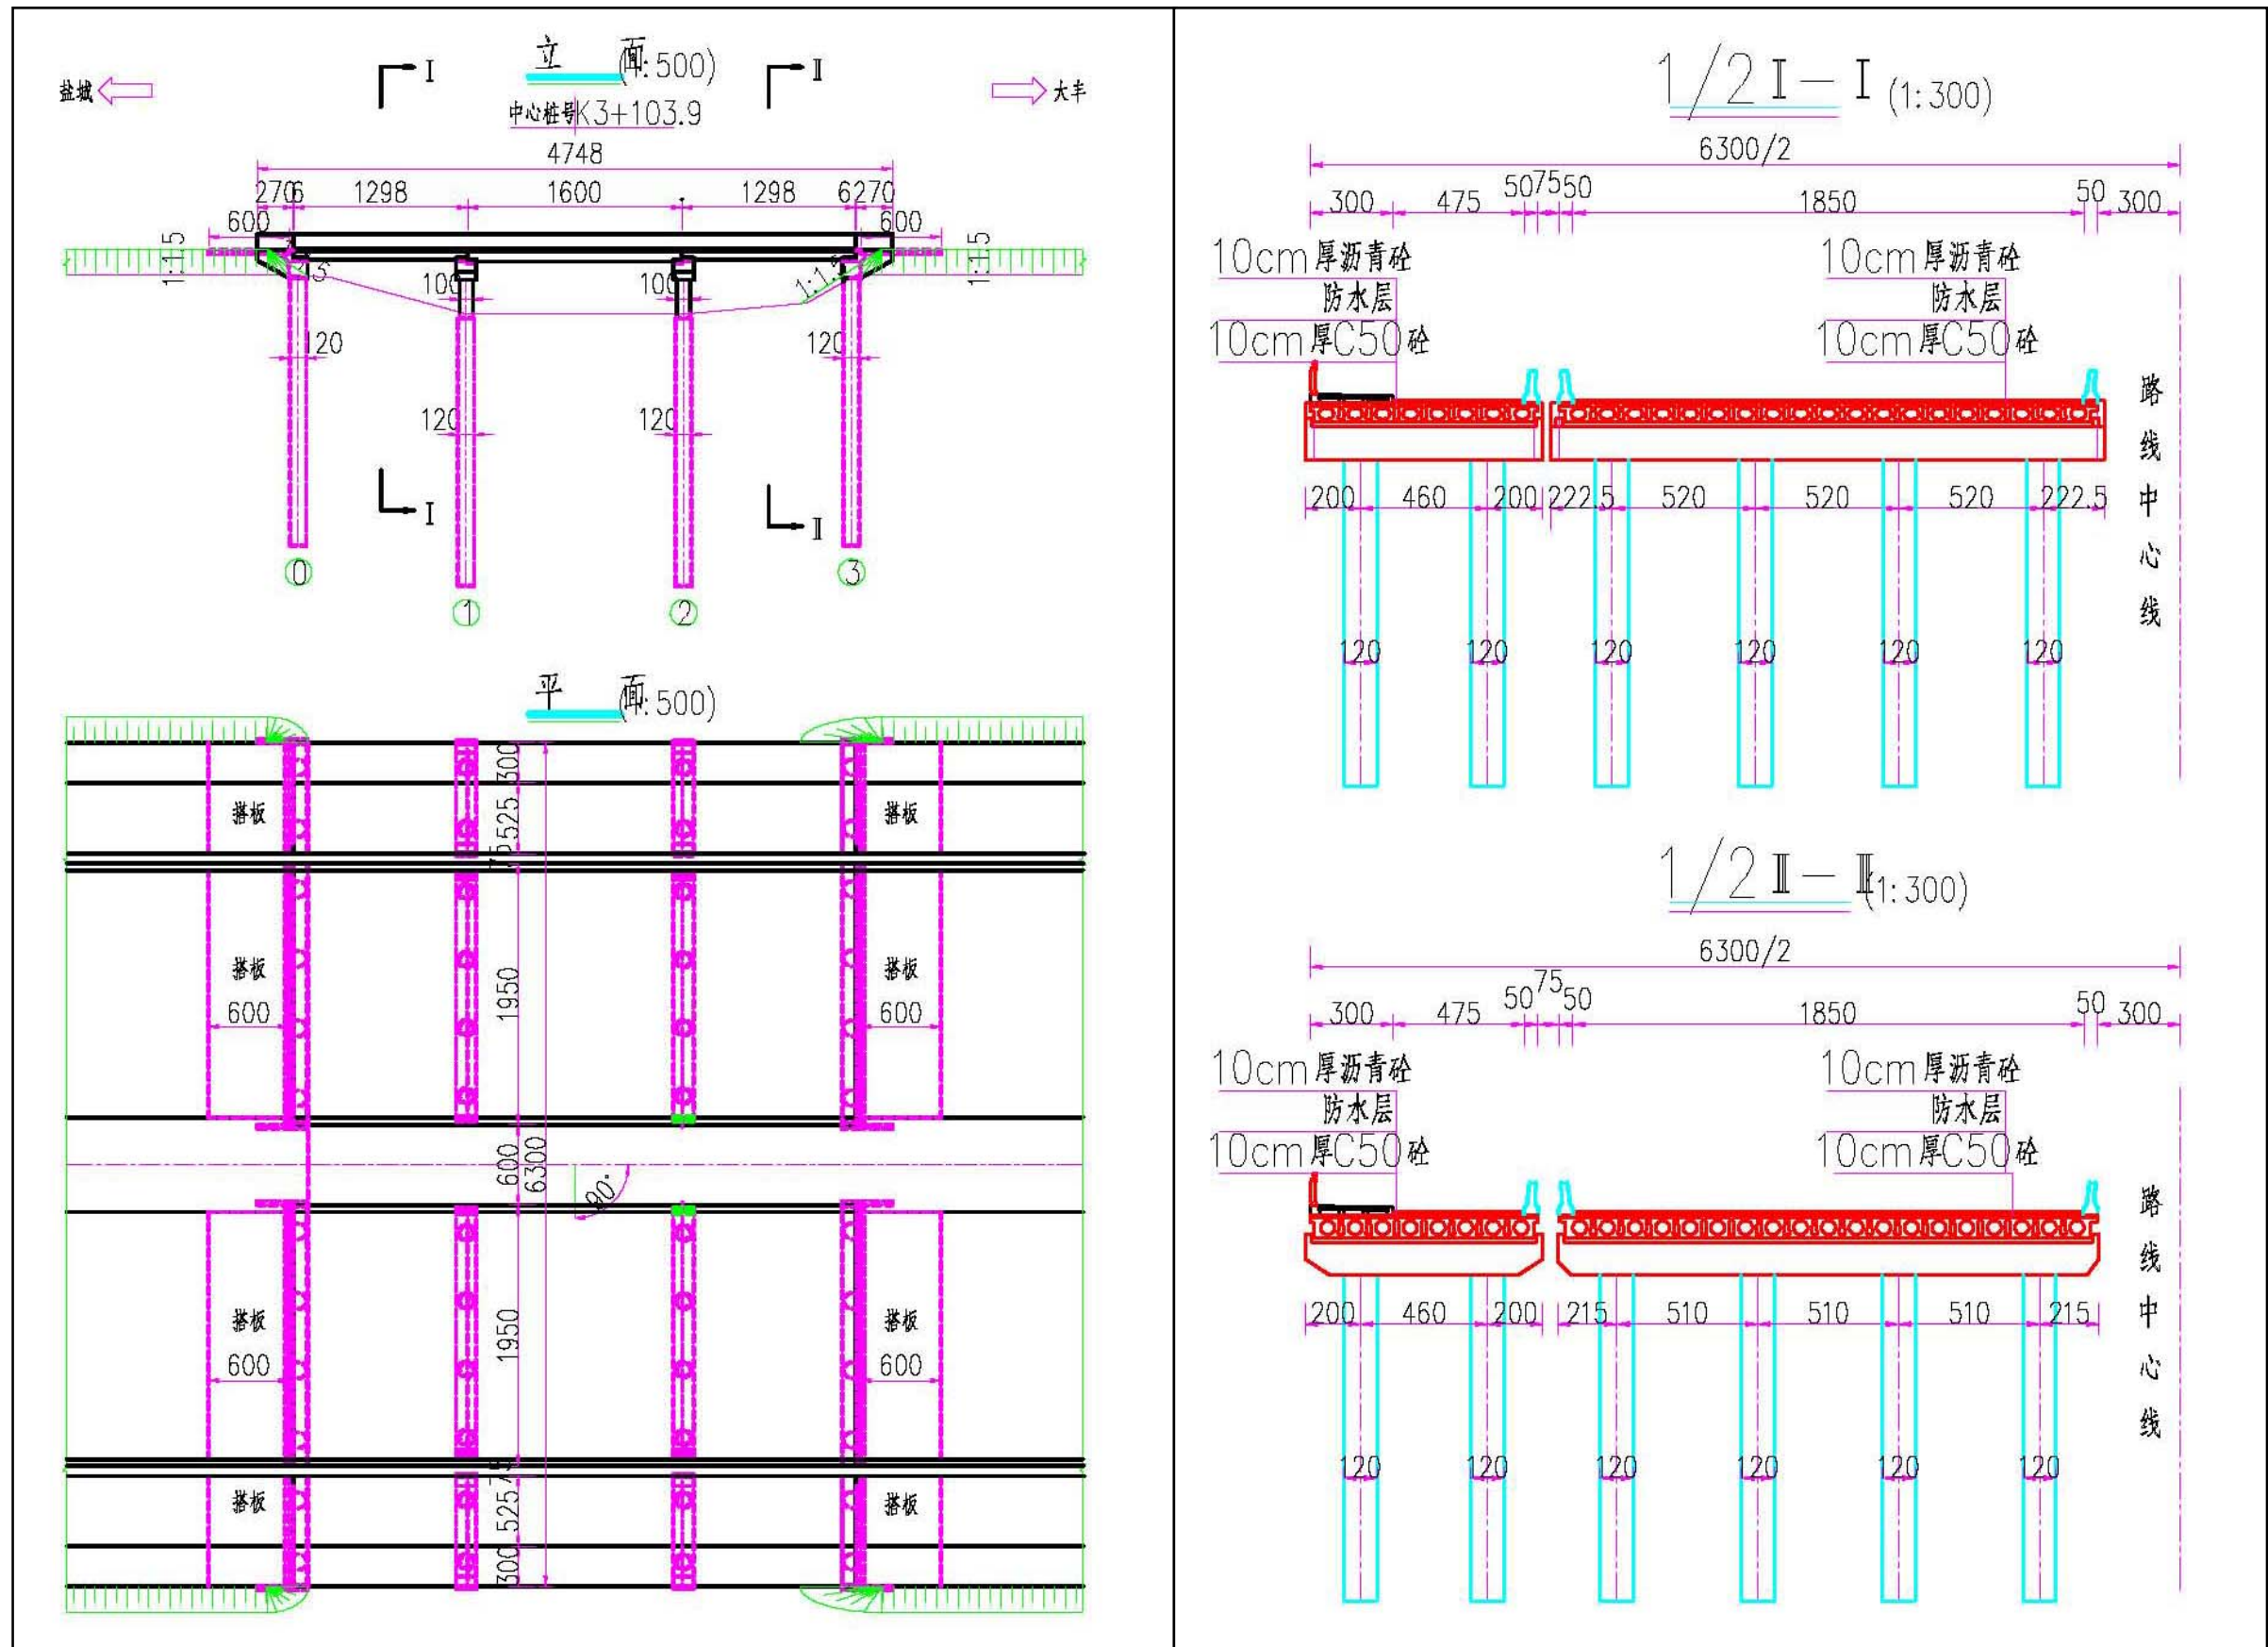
伍龙桥桥型平面布置图 (含立面、横断剖面)
